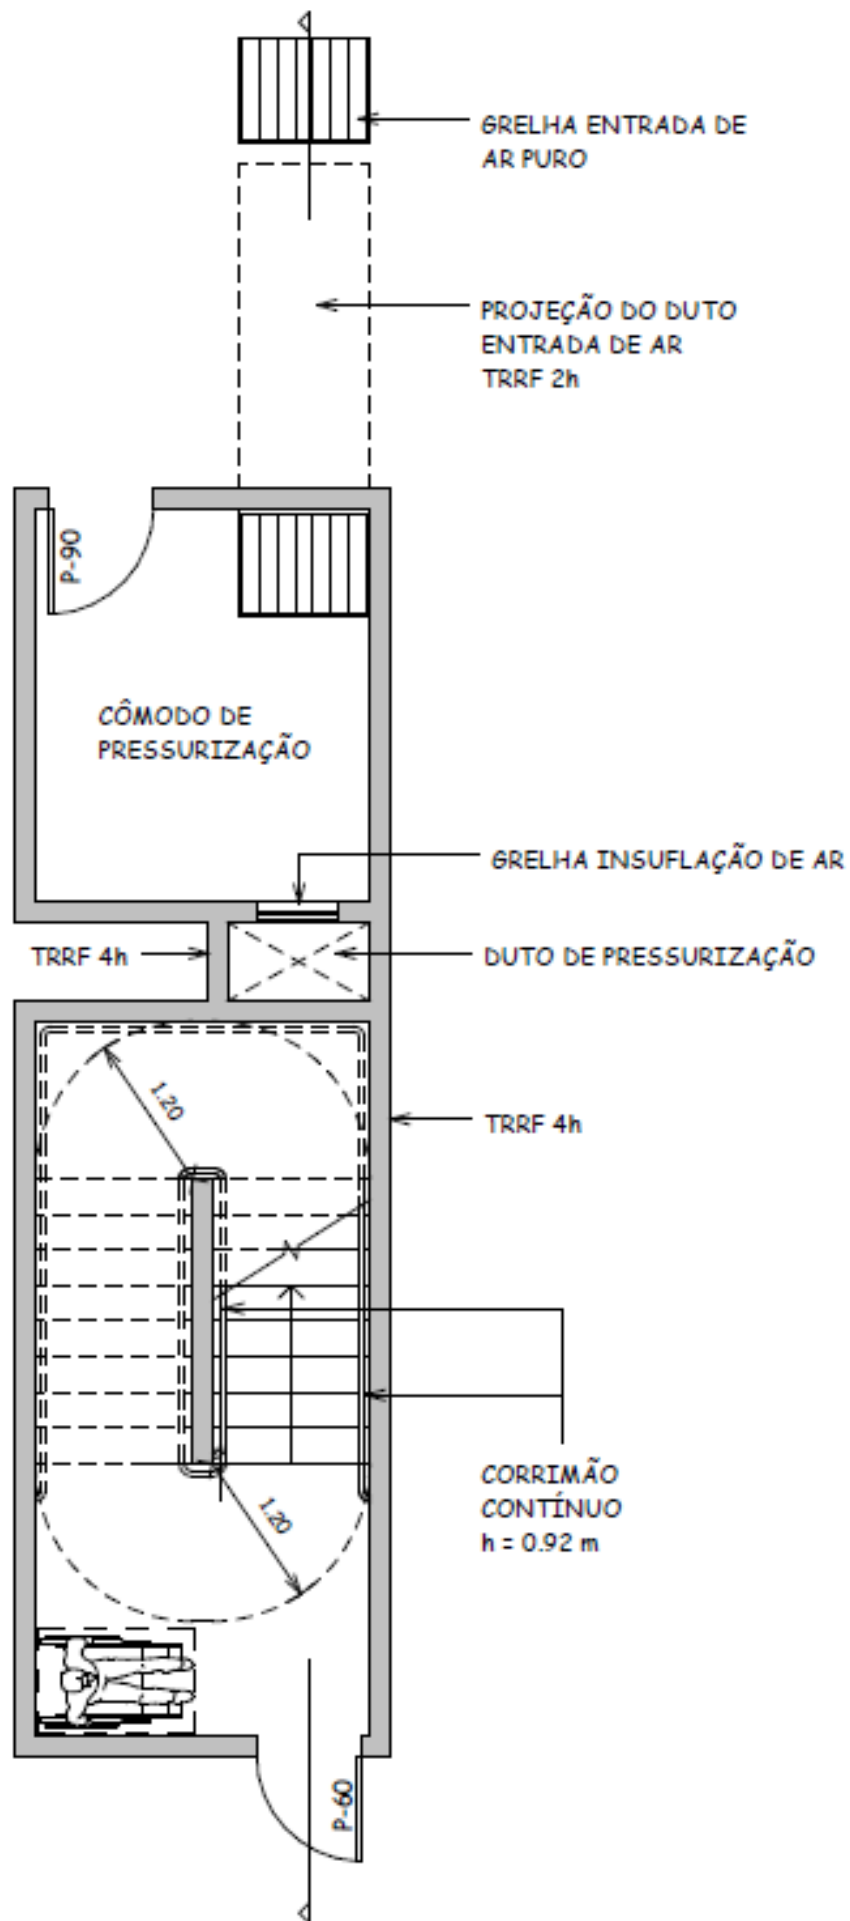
A - Escada à prova de fumaça pressurizada - térreo (planta baixa).
